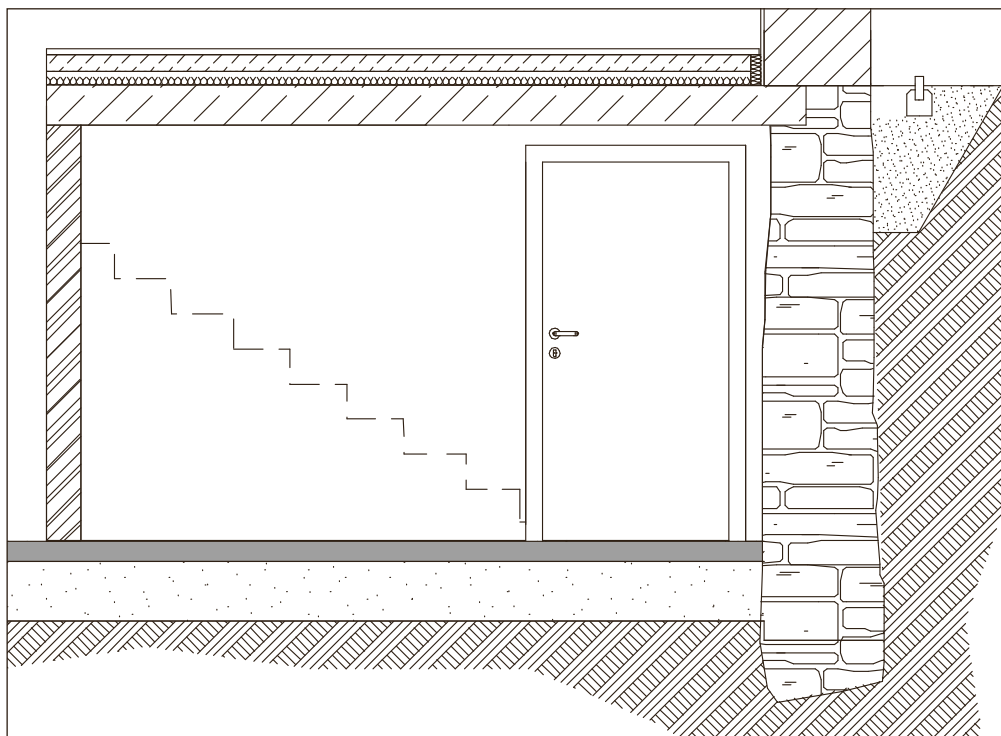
Vista sull'accesso alla cantina (Fonte: SMUL).
